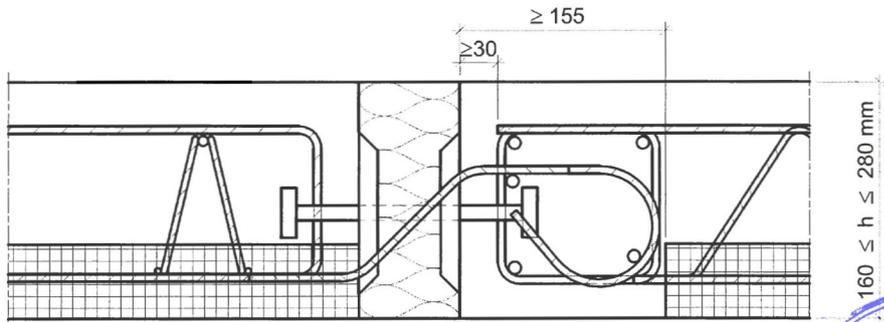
Beispiel Schöck Isokorb Typ Q (mit abgebogenem Querkraftstab) mit Elementplatten
